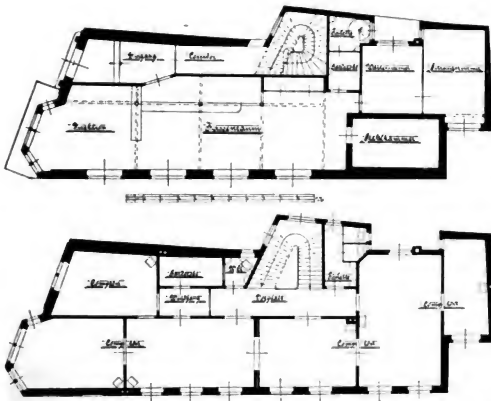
u. 390. Grundrisse der beiden Hauptgeschosse der Neuen Sparkasse am Markt.
